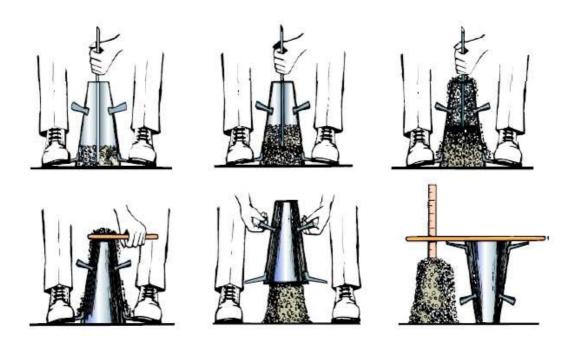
Ensaio de abatimento do concreto (SLUMP TEST).
